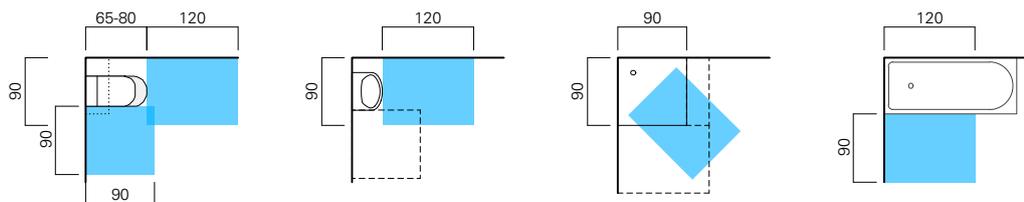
Mindestanforderungen an Bewegungsflächen für das barrierefrei anpassbare und vorbereitete Bad (ready)
